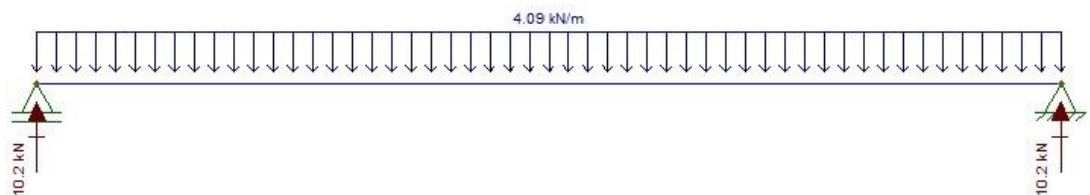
Esquema estrutural de viga biapoiada, representando as reações da laje de cobertura.
